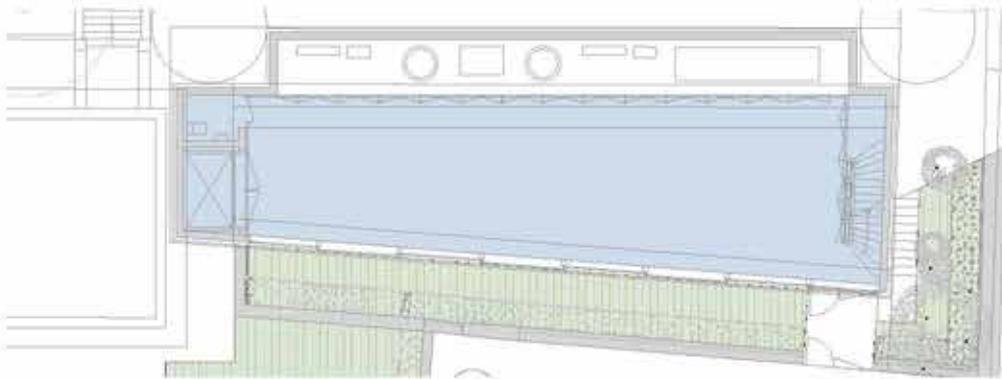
Anrechenbare Geschossfläche Untergeschoss
